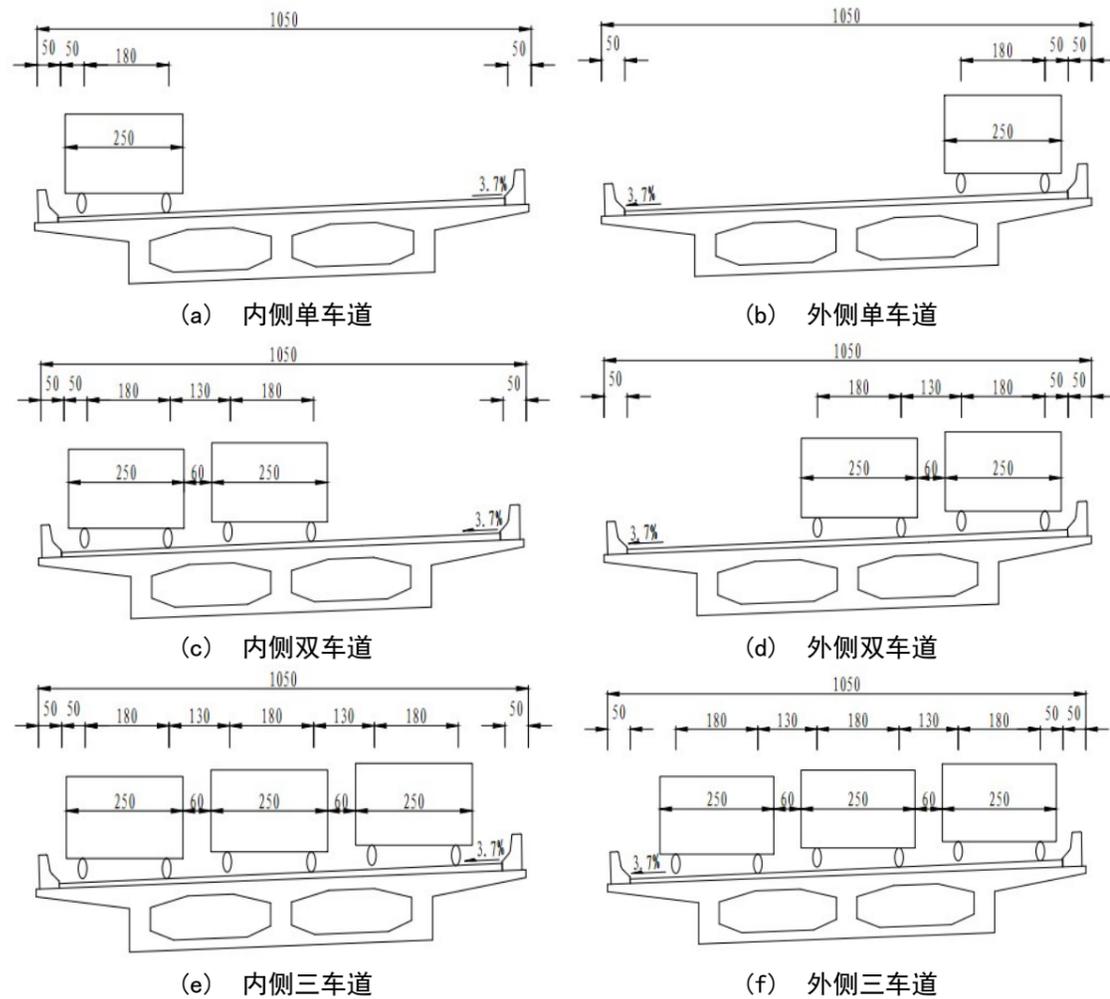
汽车荷载布置示意图 (单位: cm)
